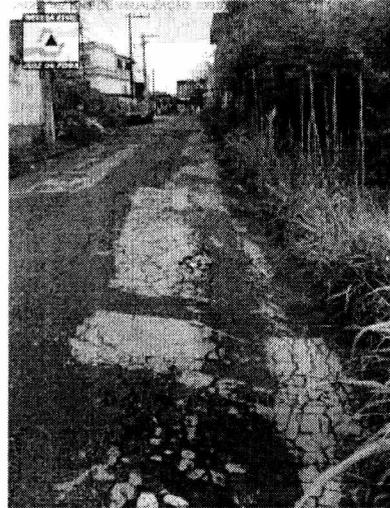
AFUNDAMENTO NO PISO ASFÁLTICO
